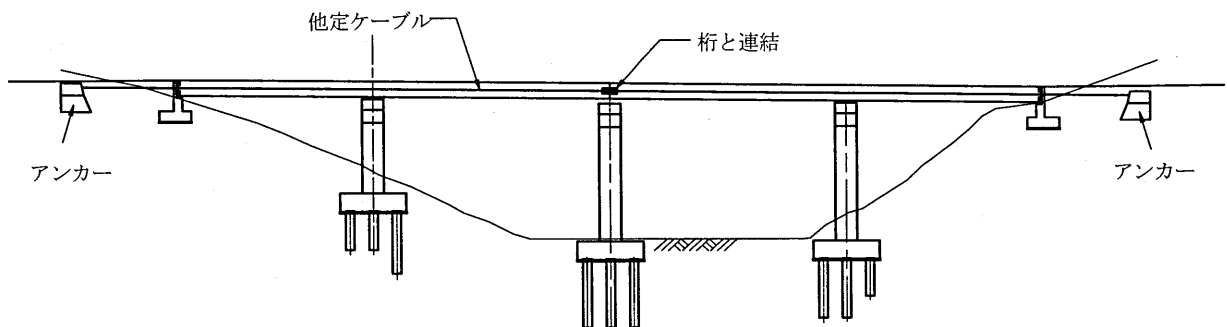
高橋脚を有する高架橋の他定ケーブルによる耐震対策の例
